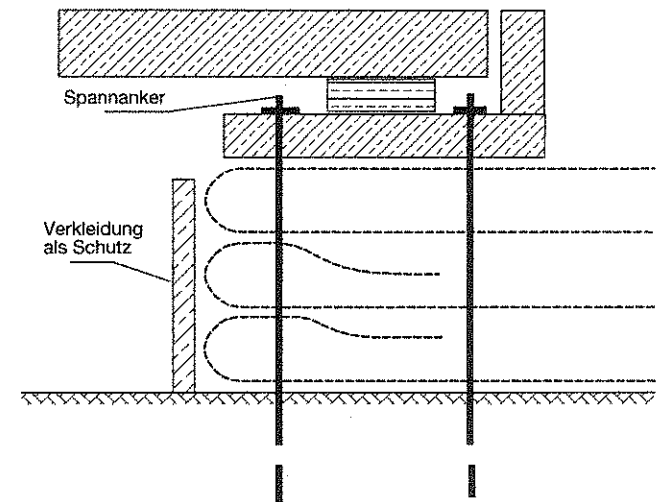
Bewehrter und vertikal vorgespannter Erdkörper als Brückenwiderlager
